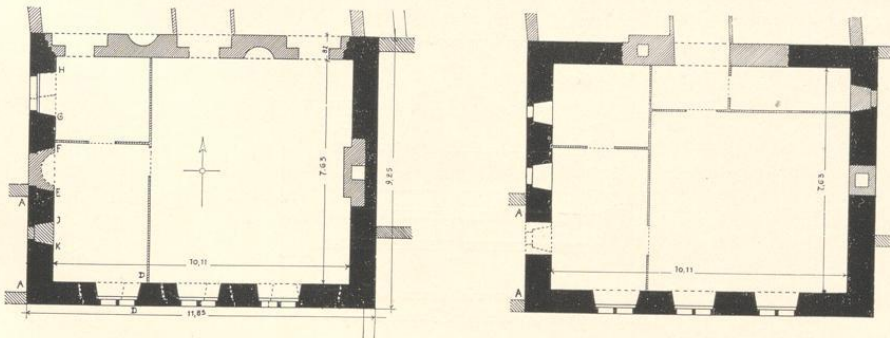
und 599. Grundrisse des Erdgeschosses und Obergeschosses; Norden oben; Maßstab 1 : 200
